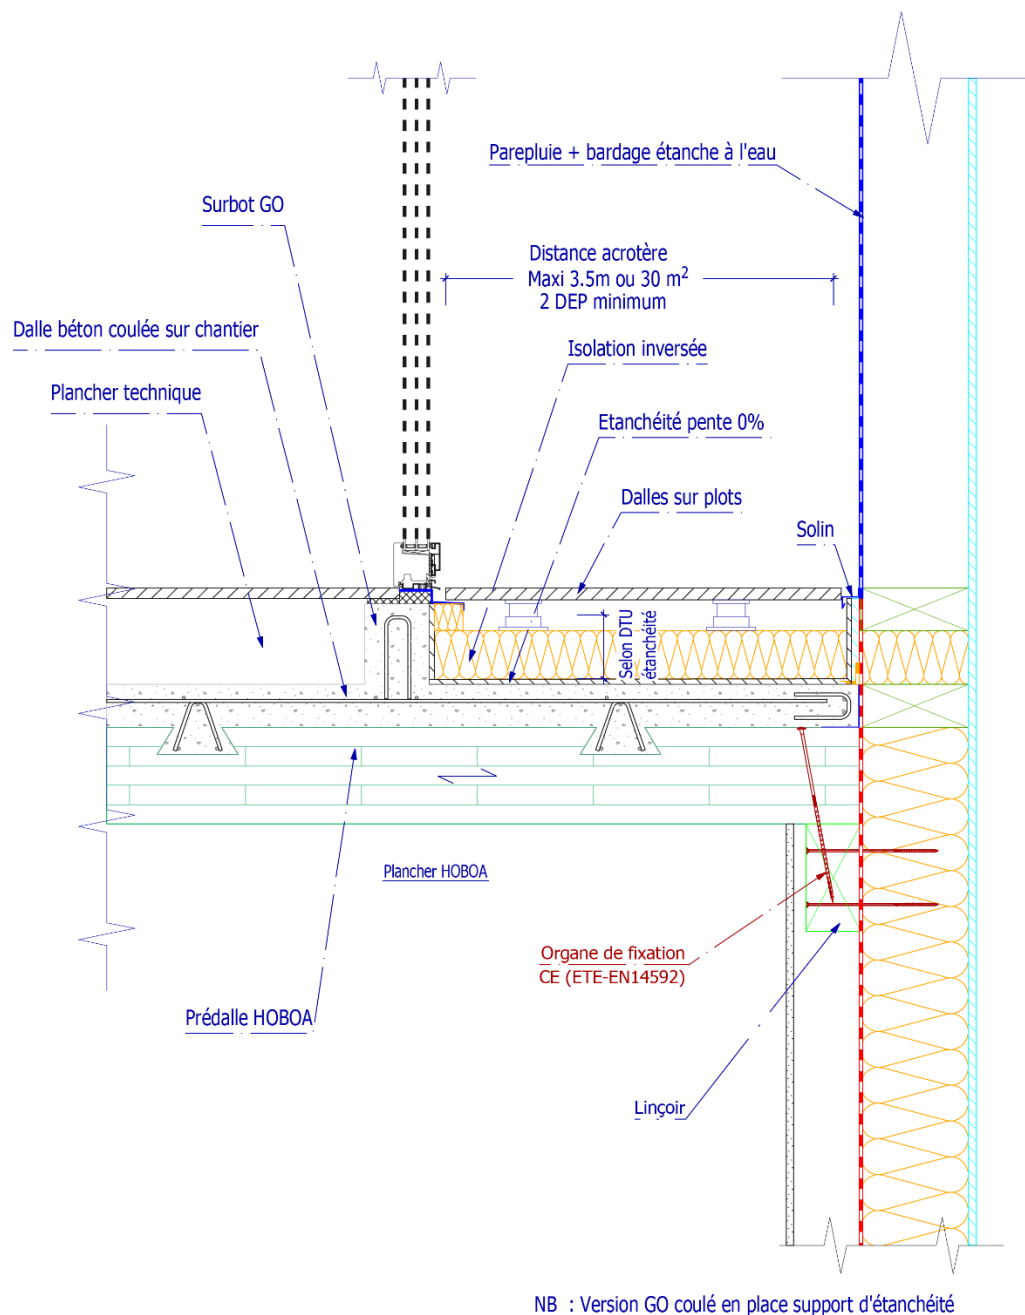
HOB OA : Dalle de compression mise en œuvre sur site - Toiture terrasse - Terrasse accessible isolation inversée [D06.1]
